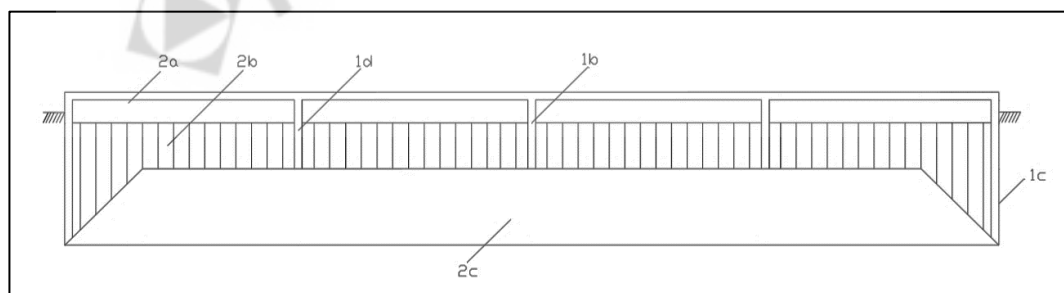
2 Penulangan bagian kolom pada pondasi sarang laba-laba
